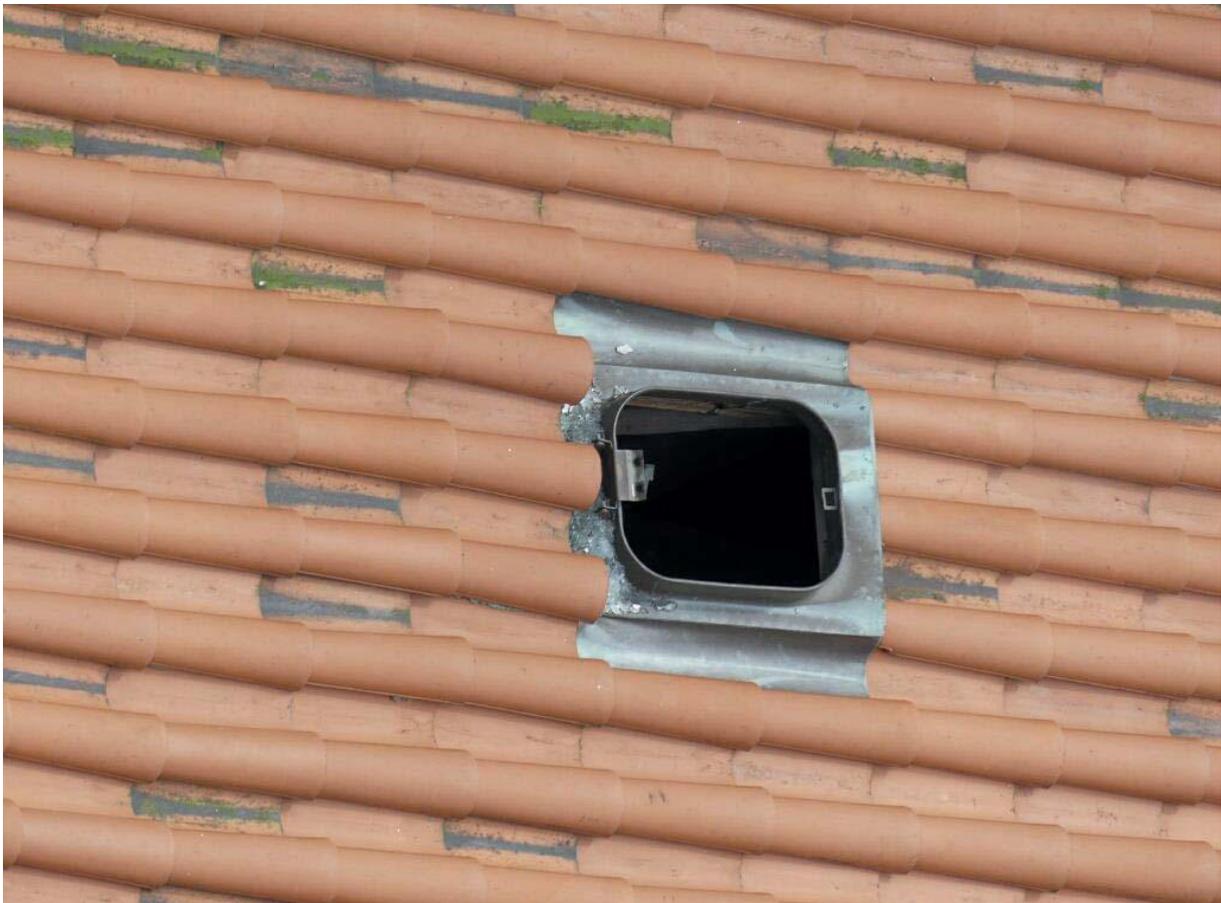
Seitenschiff: Dachluken-Deckel fehlt.
